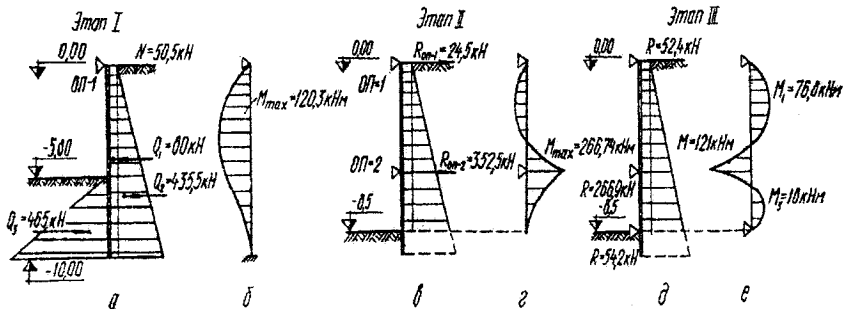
Схеми навантажень і епюри згинальних моментів при різних рівнях ґрунту в котловані: а, в, д – розрахункові схеми стіни; б, г, е – розрахункові епюри моментів
